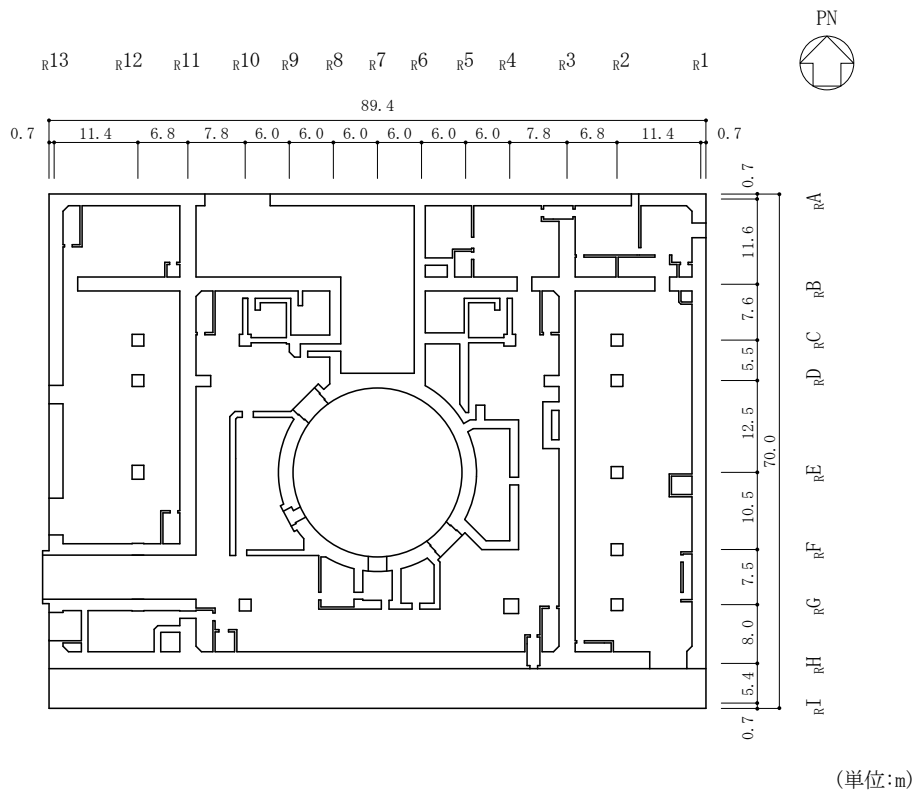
(3) 原子炉建物の概略平面図 (EL 15.3m)
